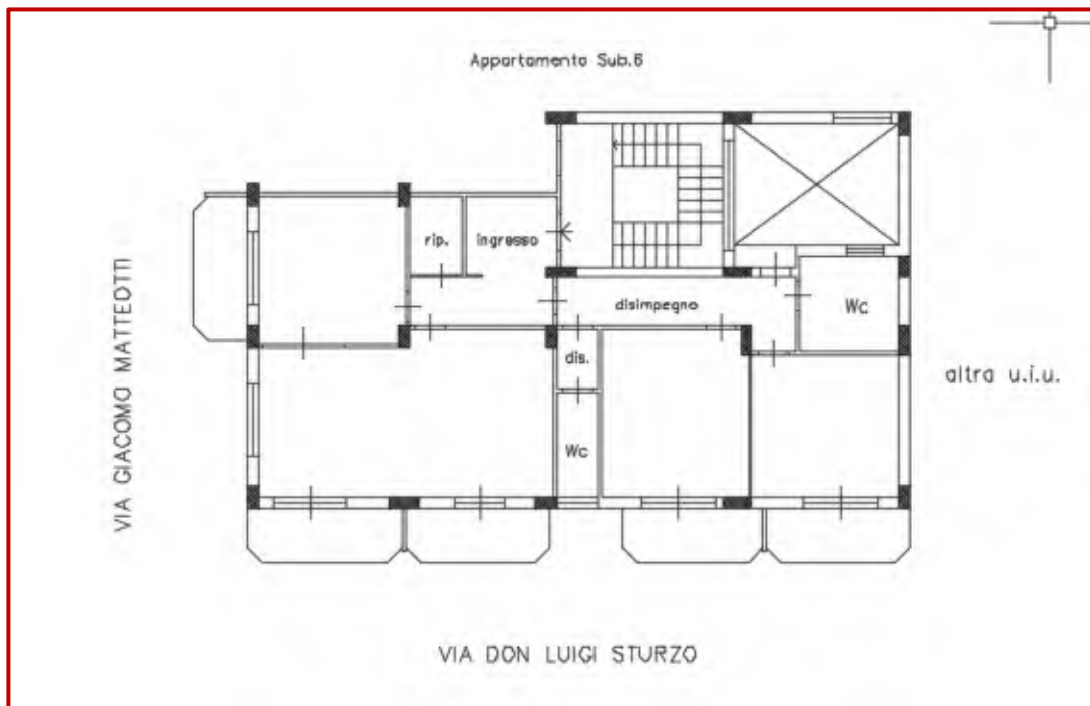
Planimetria aggiornata secondo il reale stato dei luoghi Fg.18 part. 974 sub. 7
